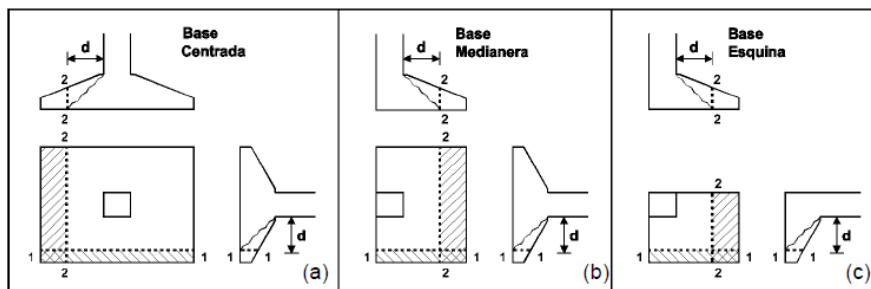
Secciones críticas para corte según tipo de zapata. Fuente: “Ejemplos de Aplicación del Proyecto del Reglamento CIRSOC 201-2005”, Balat - Bissio - Ortega.
